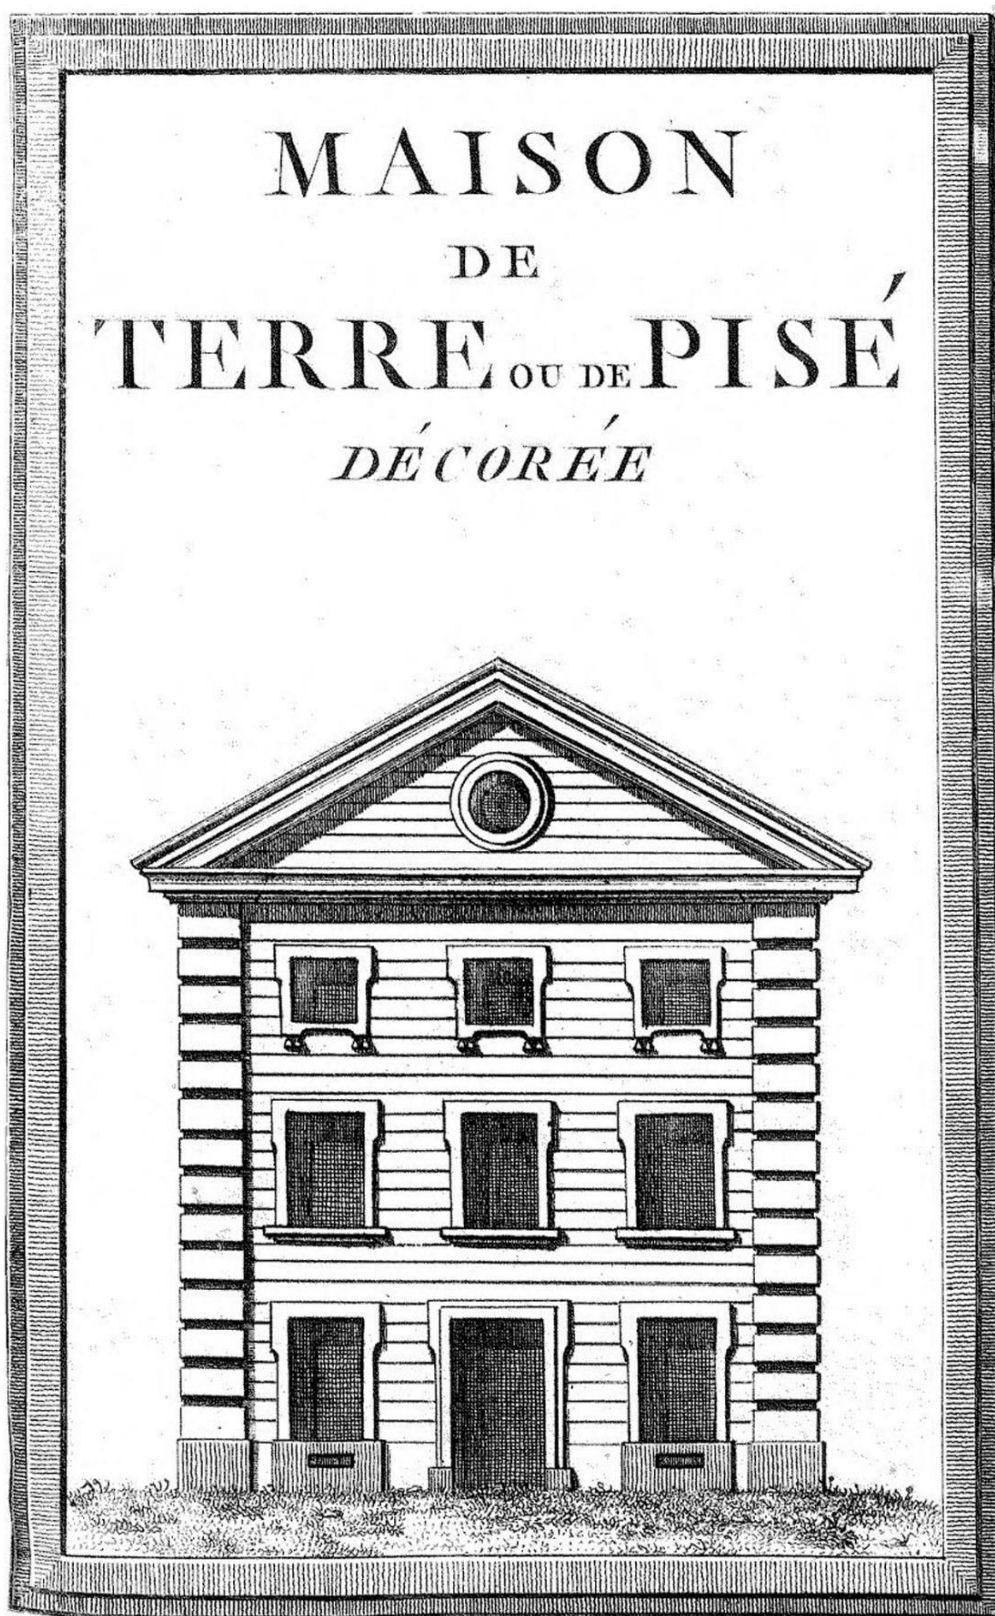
Dessin : Façade d'une « Maison de terre ou de pisé décorée » présentant des enduits moulés imitant la pierre, chaînages d'angle, bandeaux horizontaux, encadrements et fronton oculus, destinés à ennoblir l'architecture en terre crue. Source : François Cointeraux, *École d'architecture rurale*, ca. 1790–1793.
